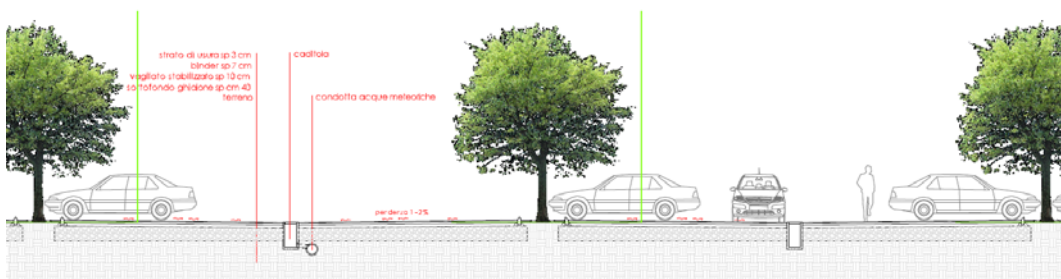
Sezione tipo della sistemazione a verde del parcheggio.
